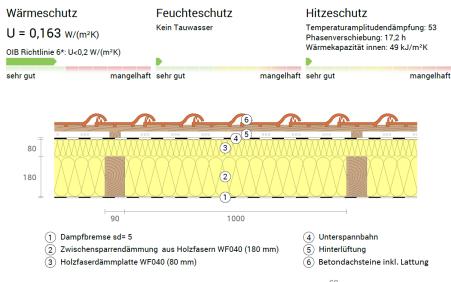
Dachaufbau - Variante 3⁶⁹
